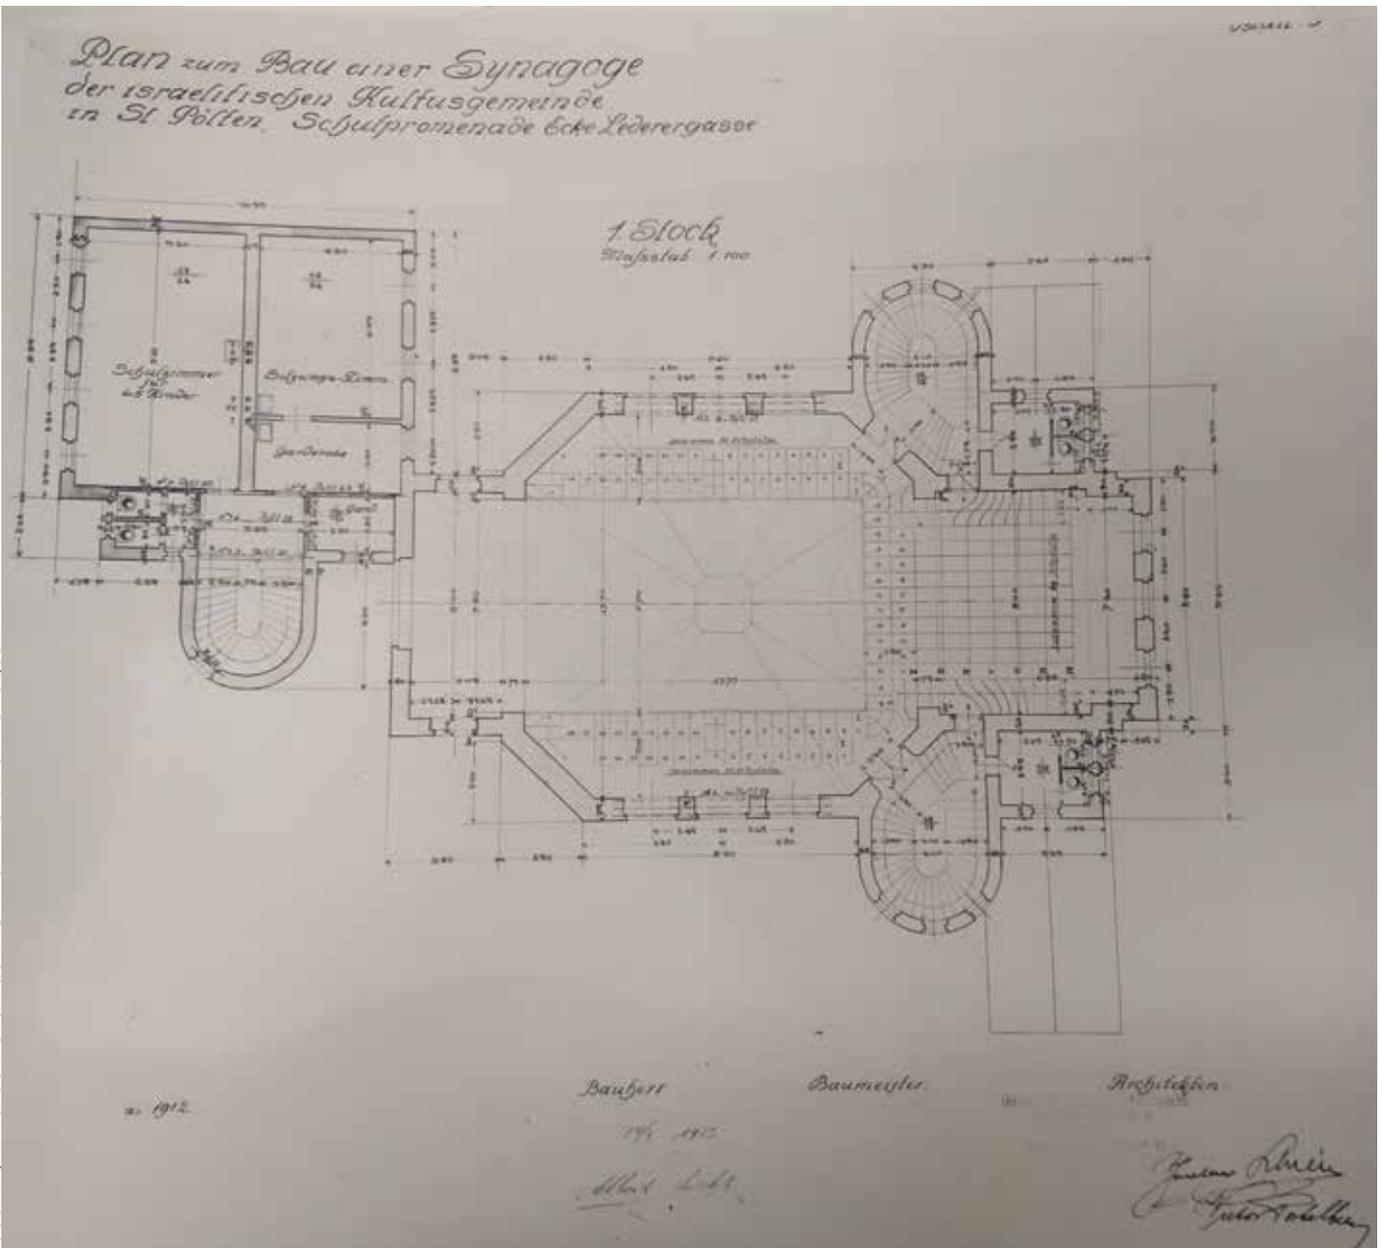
Grundrissplan vom 1. Obergeschoß, Frauengalerie, 1912
